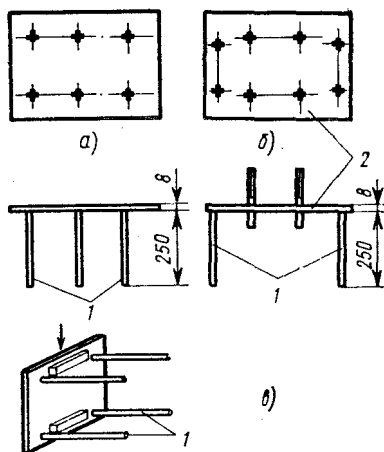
Закладные части арматуры железобетона и пример их расположения в колонне
